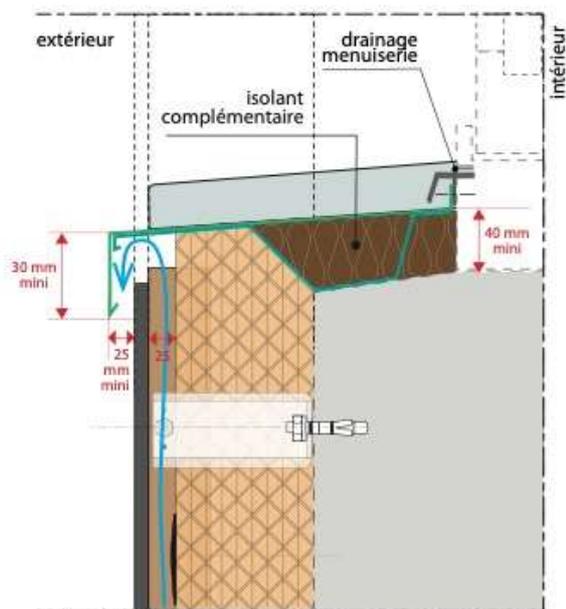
Coupe sur appui de baie posée au nu intérieur
